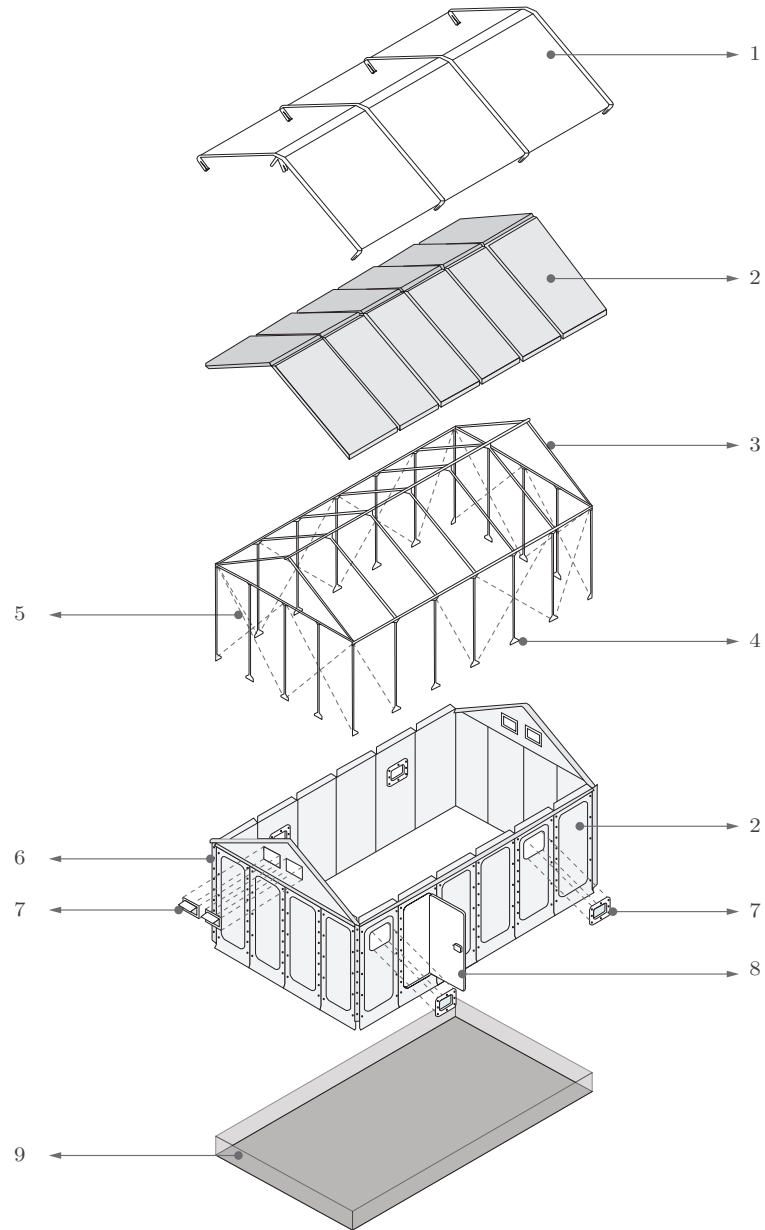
Detalle del ensamblaje simple de la estructura de RHU. Fuente: [Fahlén \(2017\)](#). Elaboración: Autores.
